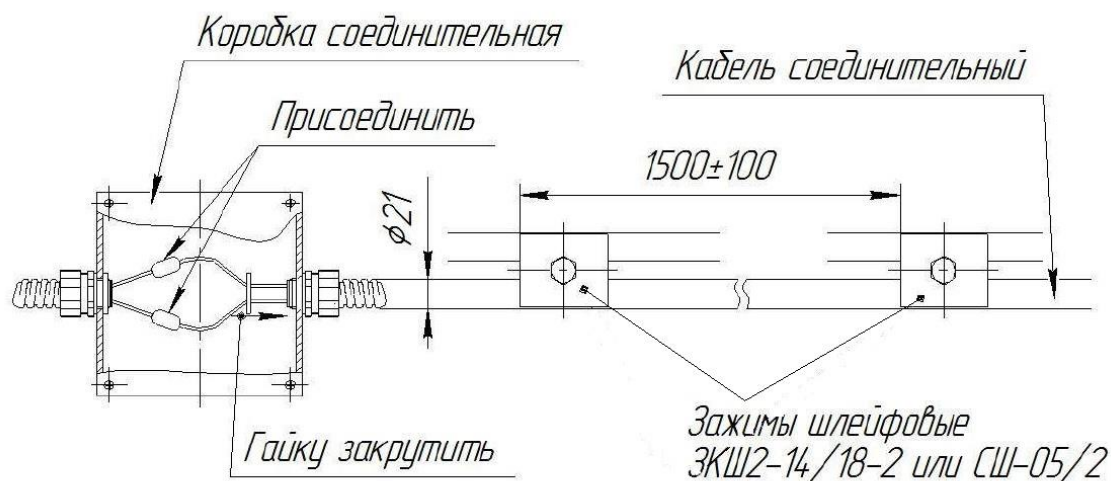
Присоединение и монтаж кабеля соединительного к устройству E-TOR-110-PN.
